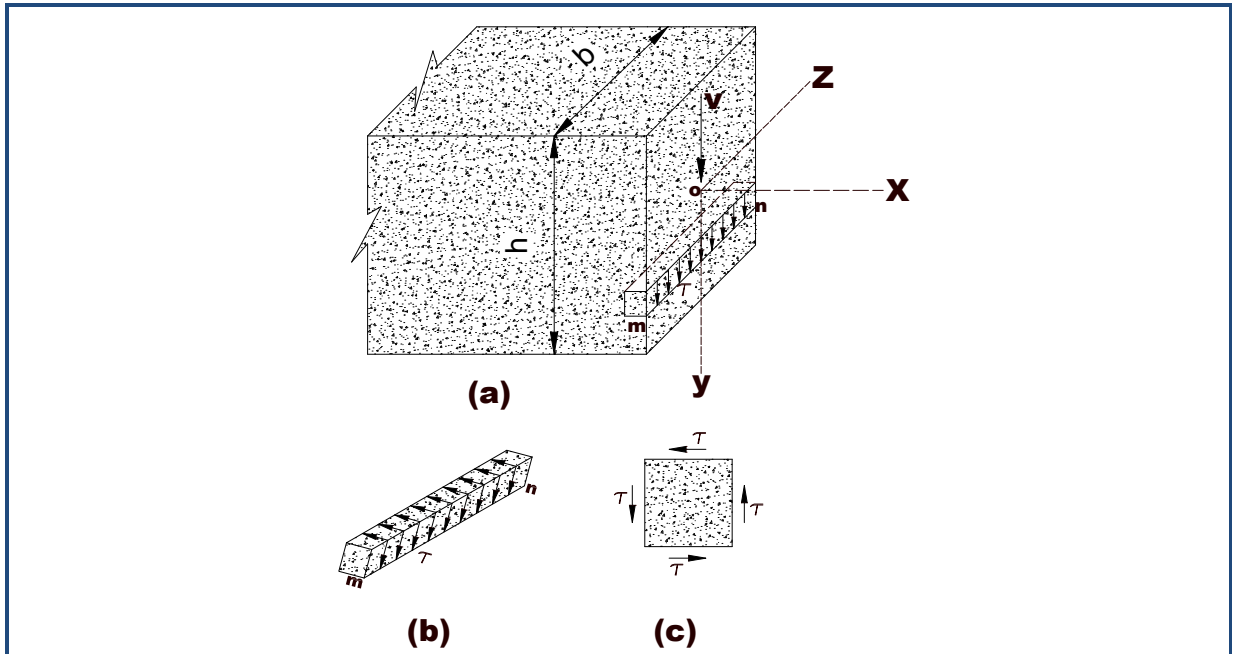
Esfuerzos cortantes en una viga de sección transversal rectangular
